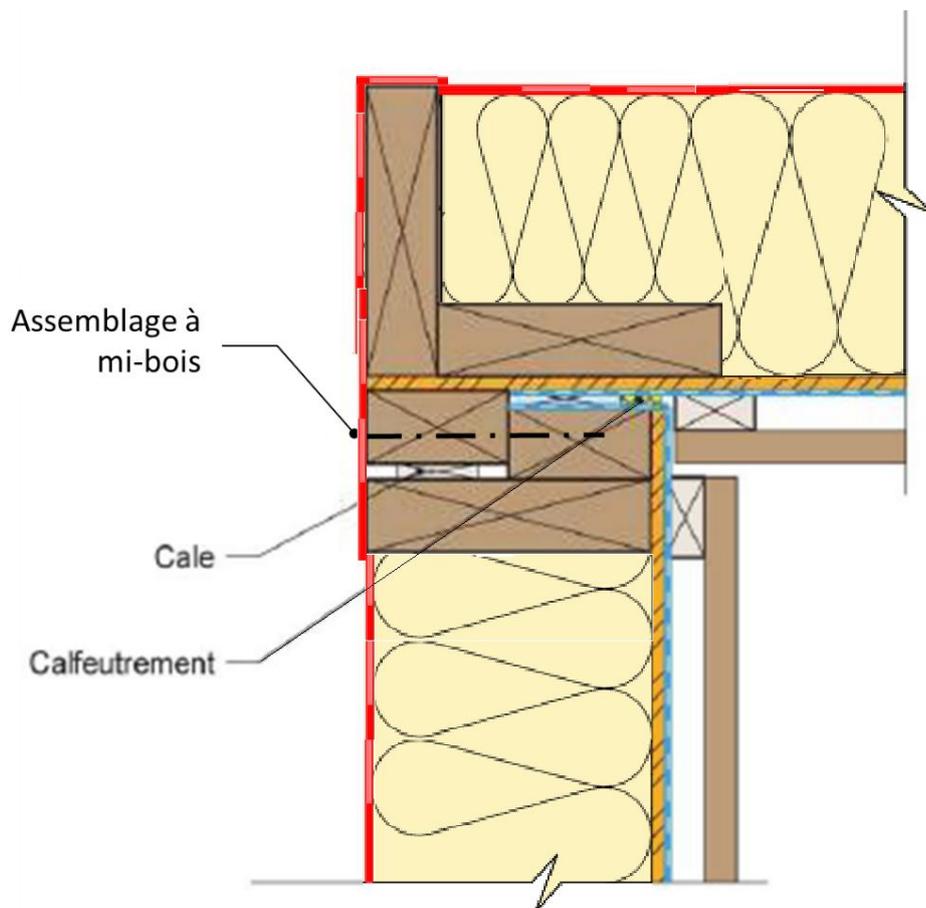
Exemple de positionnement du calfeutrement dans le plan du pare-pluie et assemblage à mi-bois dans le cas d'un angle rentrant (coupe horizontale)
